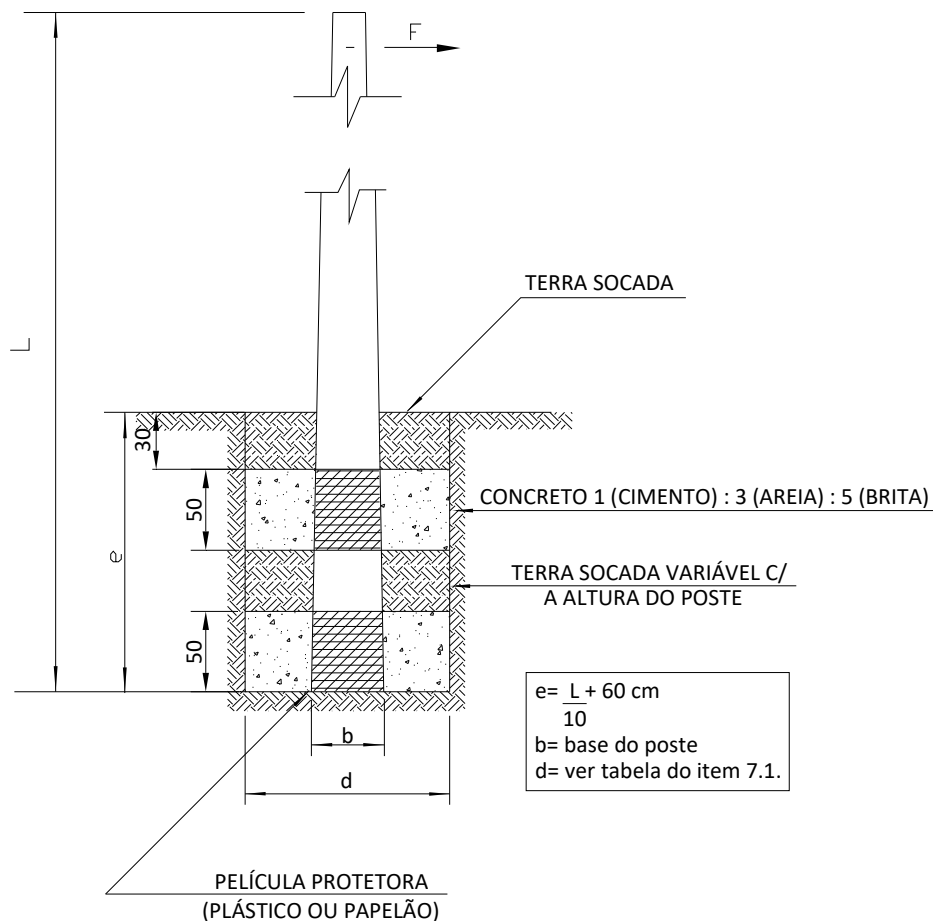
ENGASTAMENTO COM CONCRETAGEM DE CAVA
